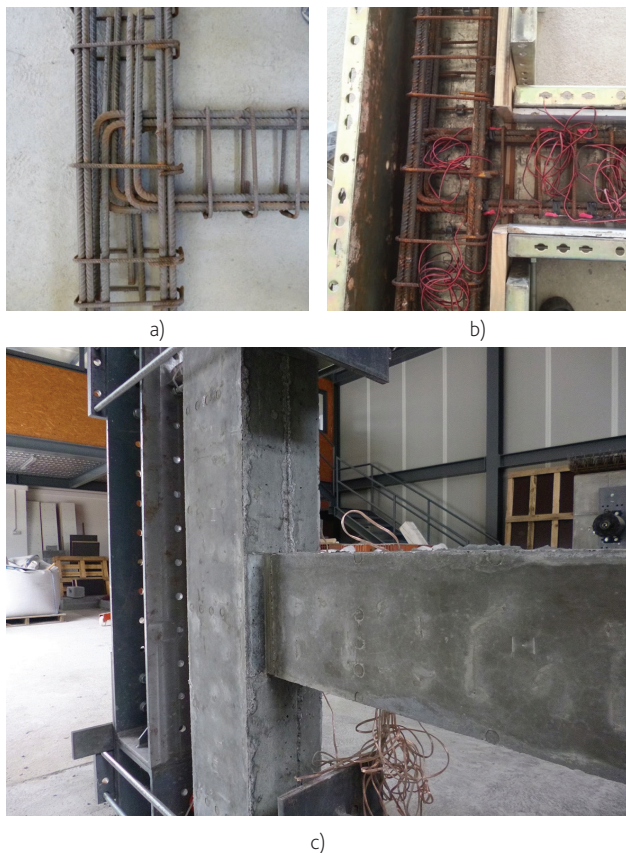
Produção dos elementos: a) pormenorização da armadura no nó; b) armadura com extensómetros na cofragem; c) elemento BC 5 com o pilar com maior secção transversal
